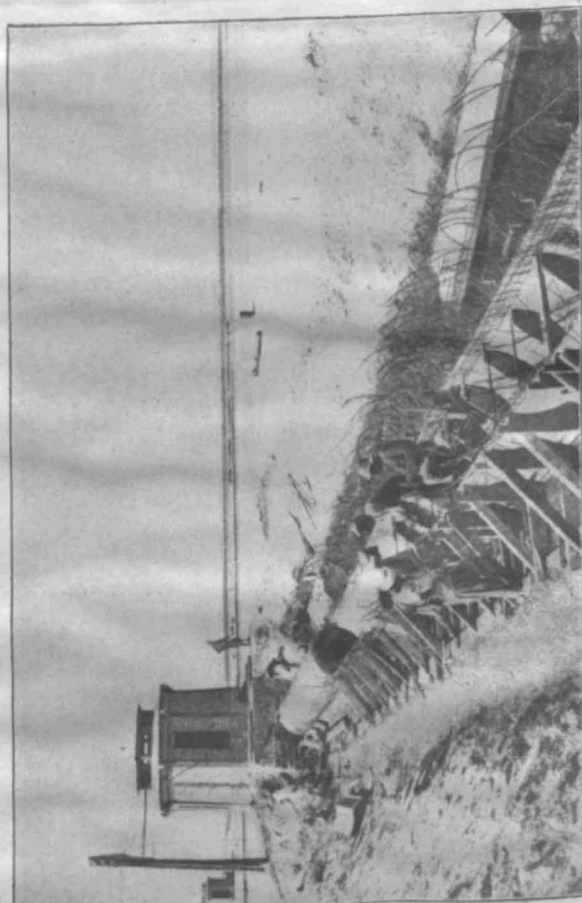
Geschl. Eisenbeton-Wasserlgt. in Port Said zwischen Dücker und Wasserwerk.
